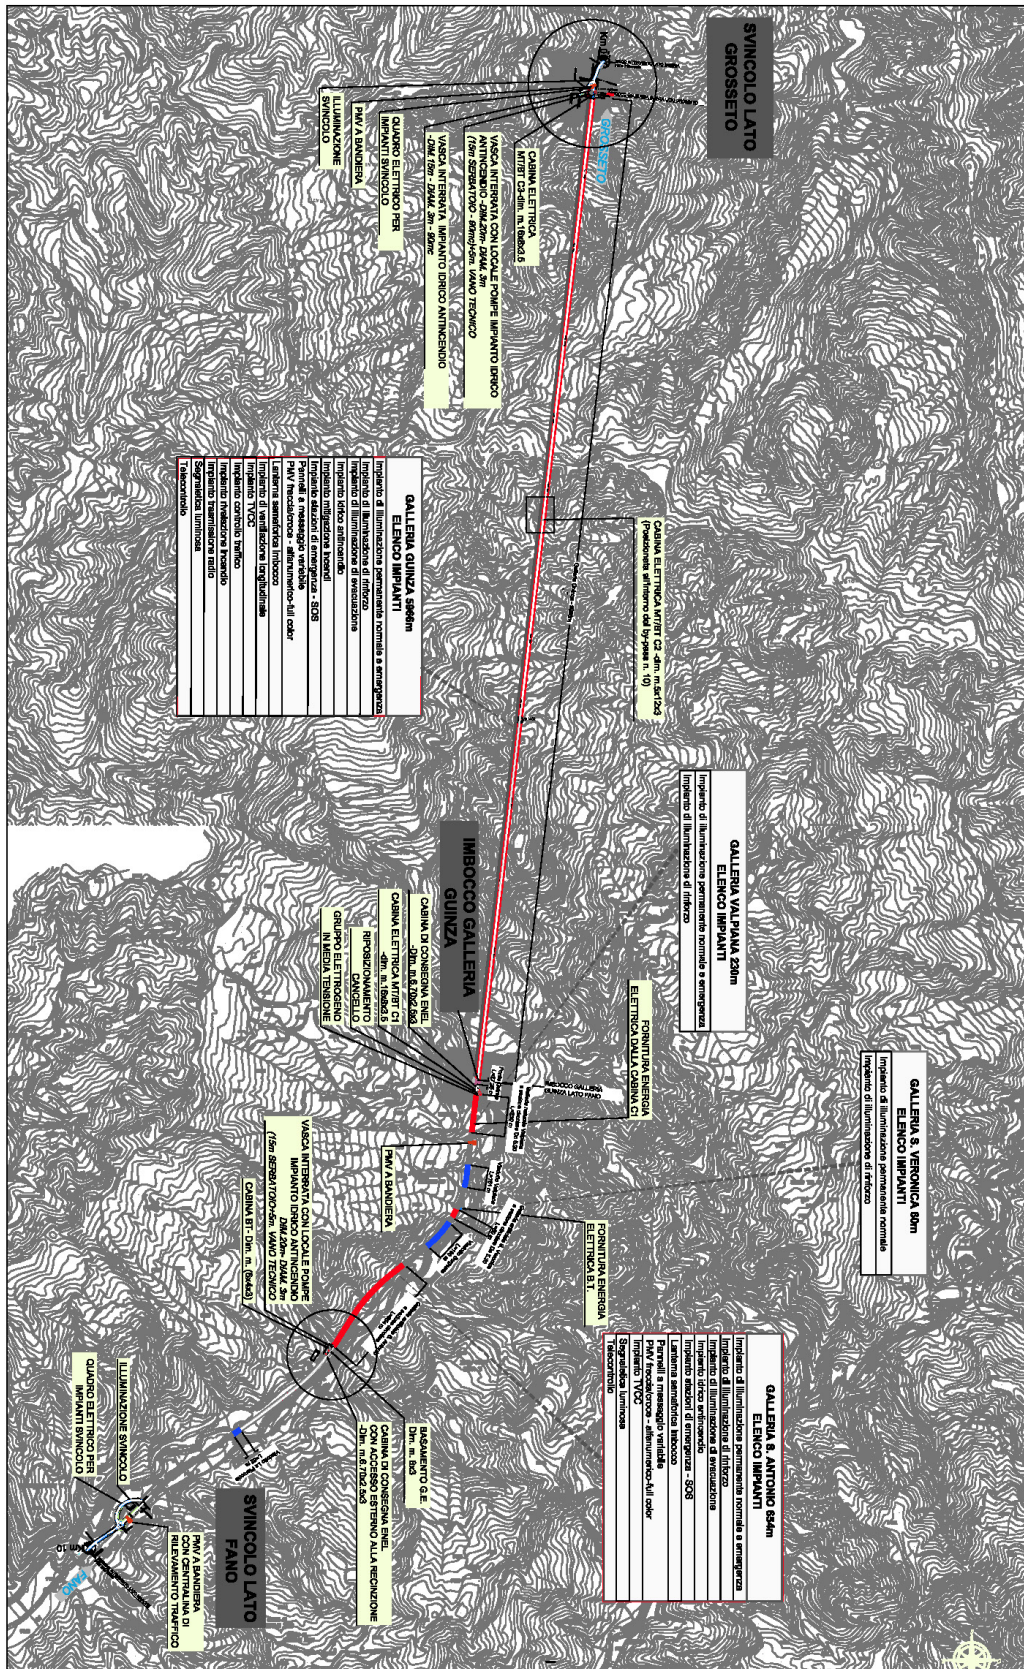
planimetria dell'area oggetto di intervento con individuazione degli impianti
